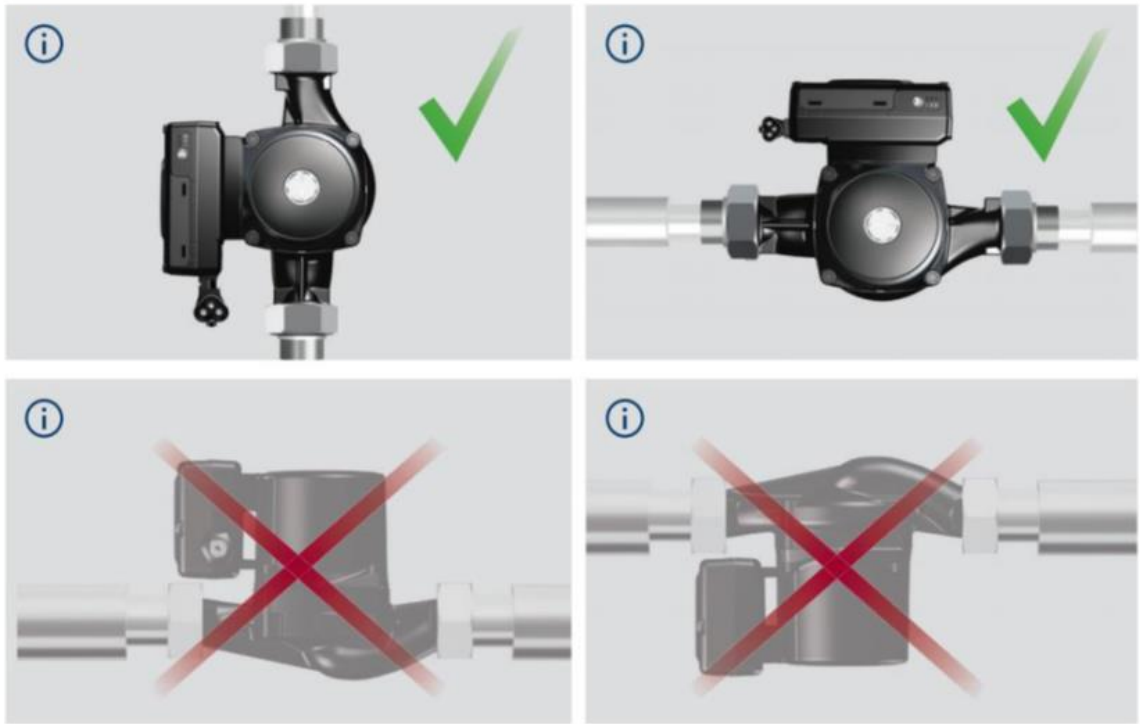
Zulässige Positionen vom Steuerungskasten
